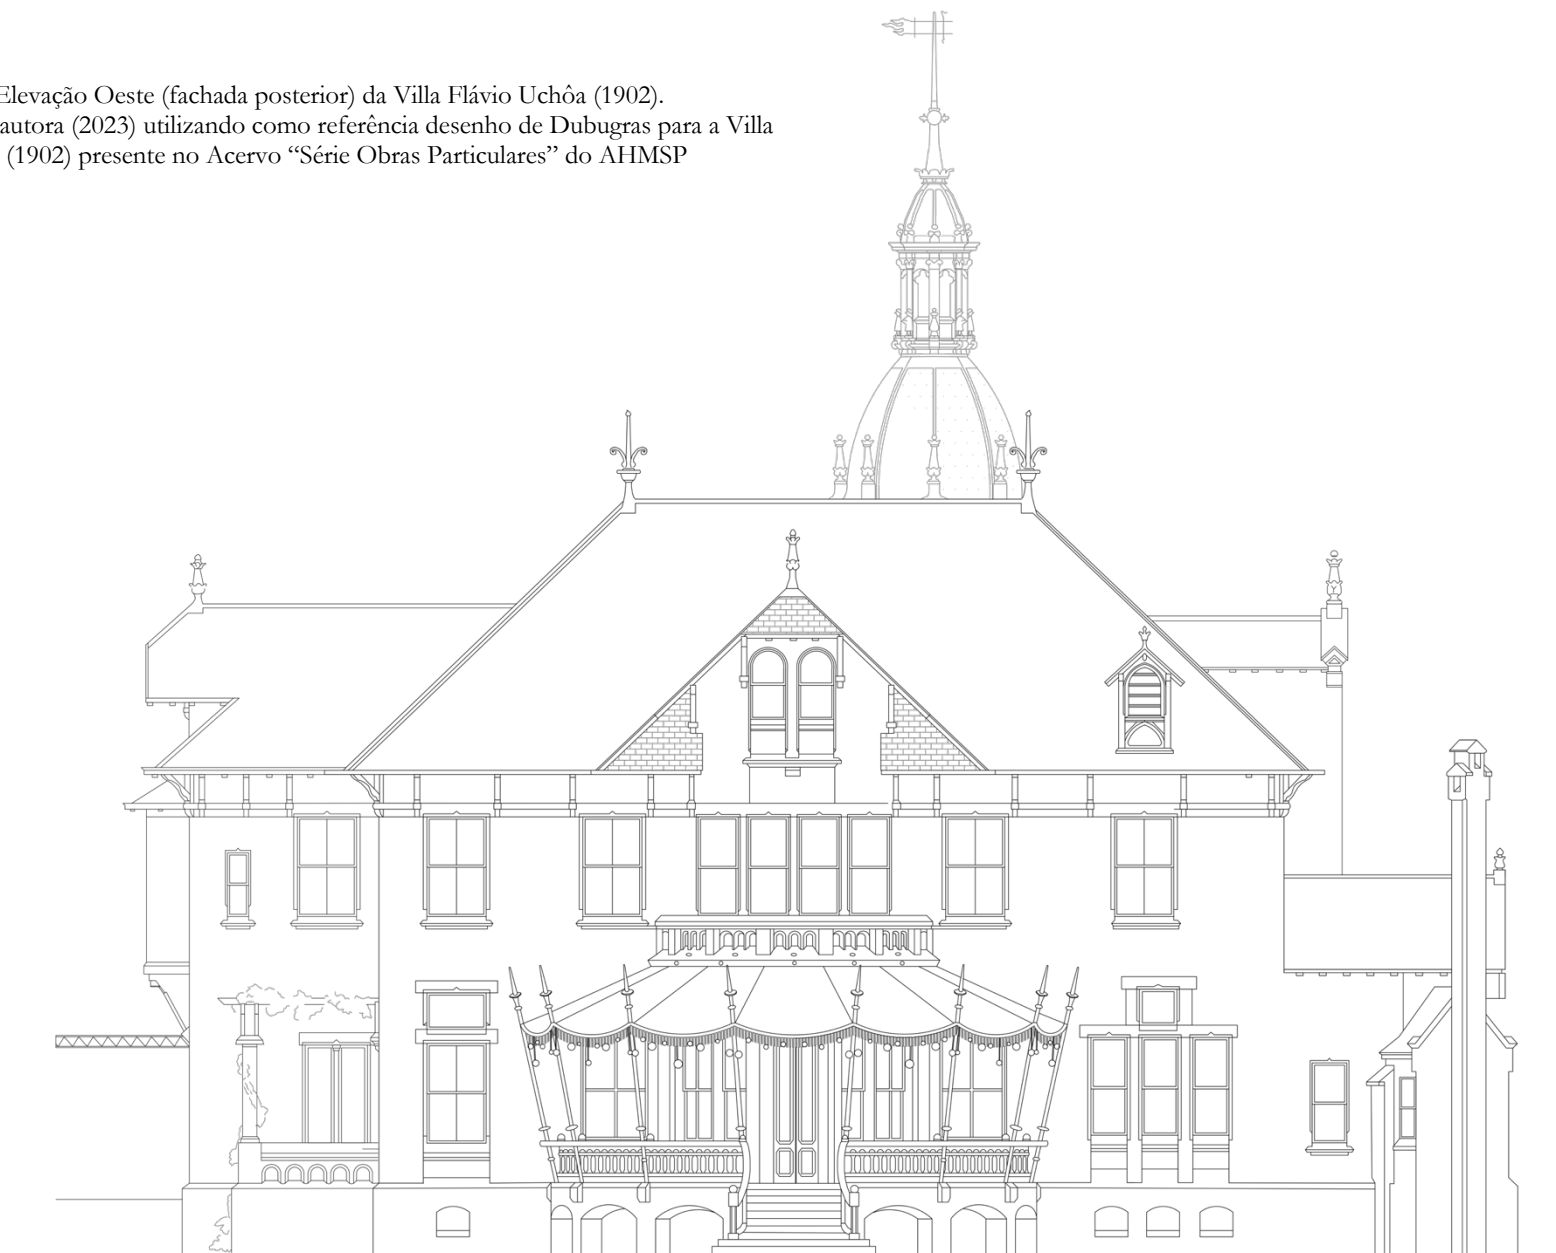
Elevação Oeste (fachada posterior) da Villa Flávio Uchôa (1902).
